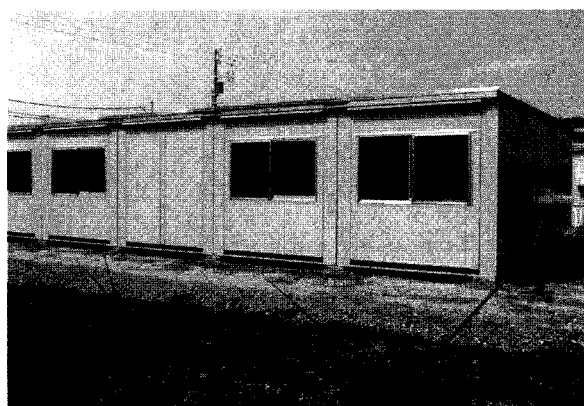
Constructions temporaires à ossatures métalliques à murs autostables
